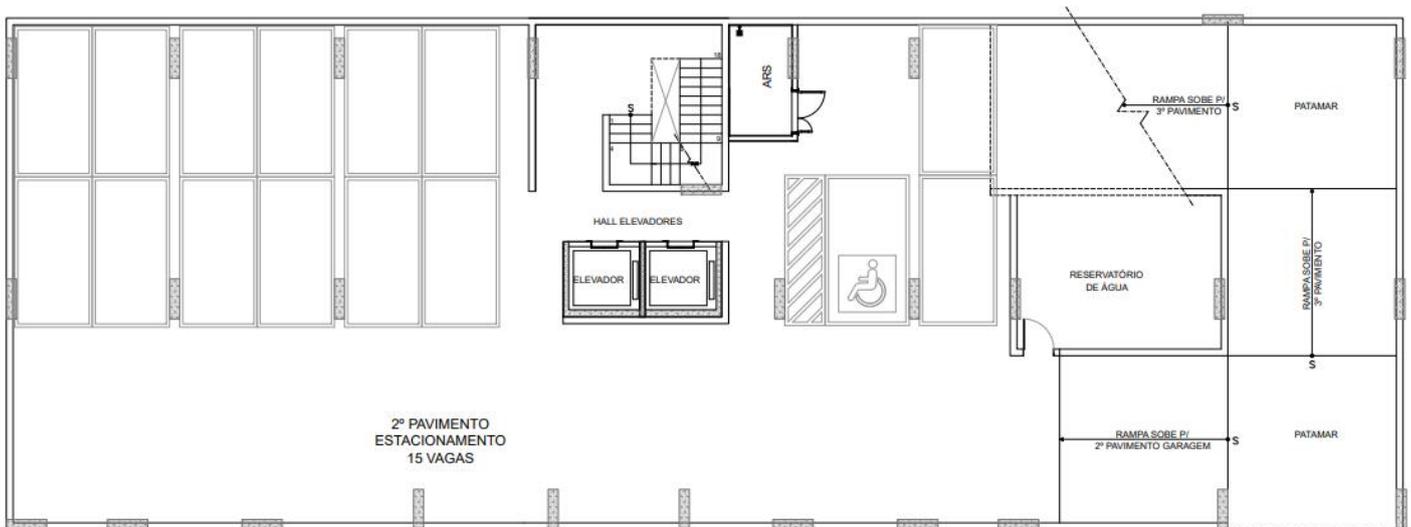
BLOCO COMERCIAL - 2º Pavimento
